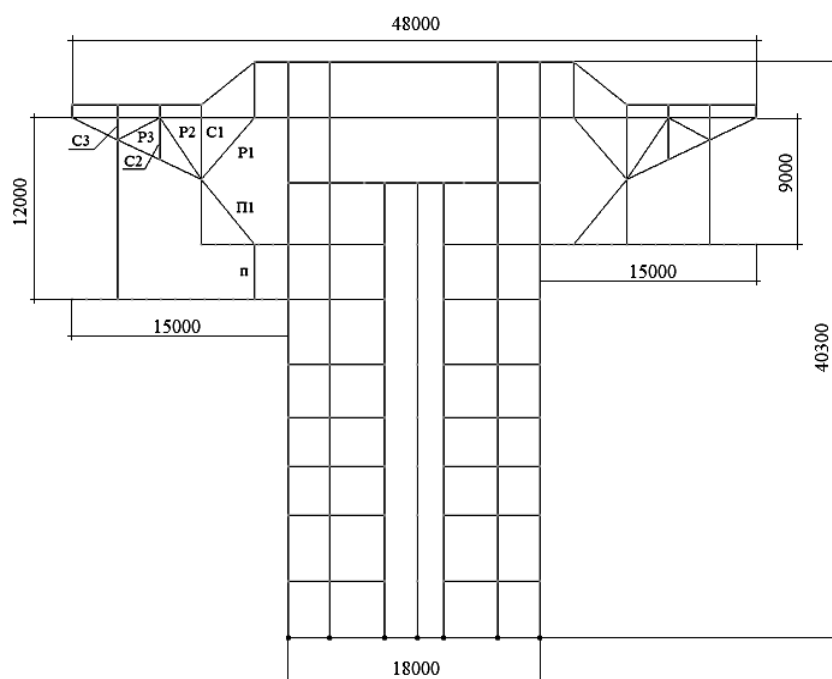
Схема расположения наиболее нагруженных конструкций здания в осях С-7—С-15: С — Стойка фермы; Р — Раскос фермы; П — Подкос фермы; п — подвеска спирального этажа
